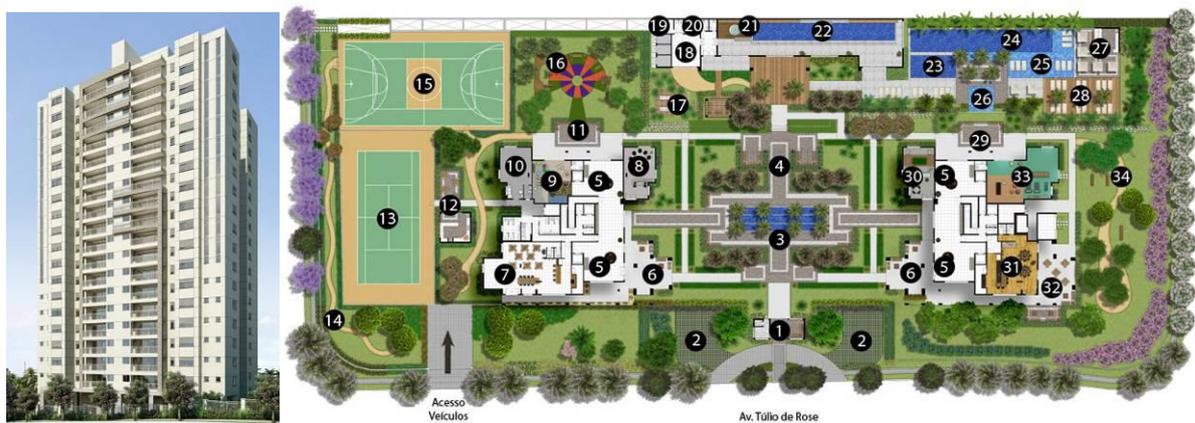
fachada e implantação do empreendimento L3. Fonte: empresa L.
